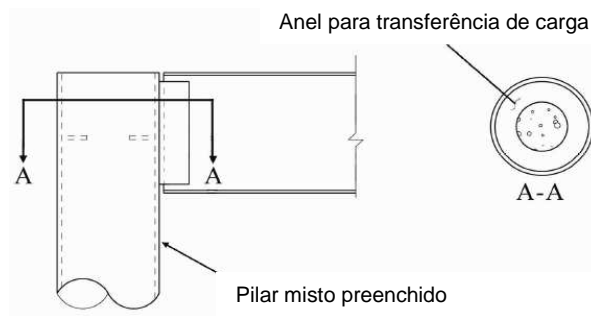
Anel para transferência de carga entre os componentes de aço e de concreto de um pilar misto preenchido (Jacobs e Hajjar, 2010).
